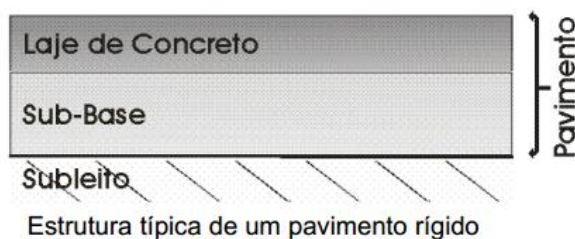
Esquema de um pavimento rígido. (Oliveira,2016)
